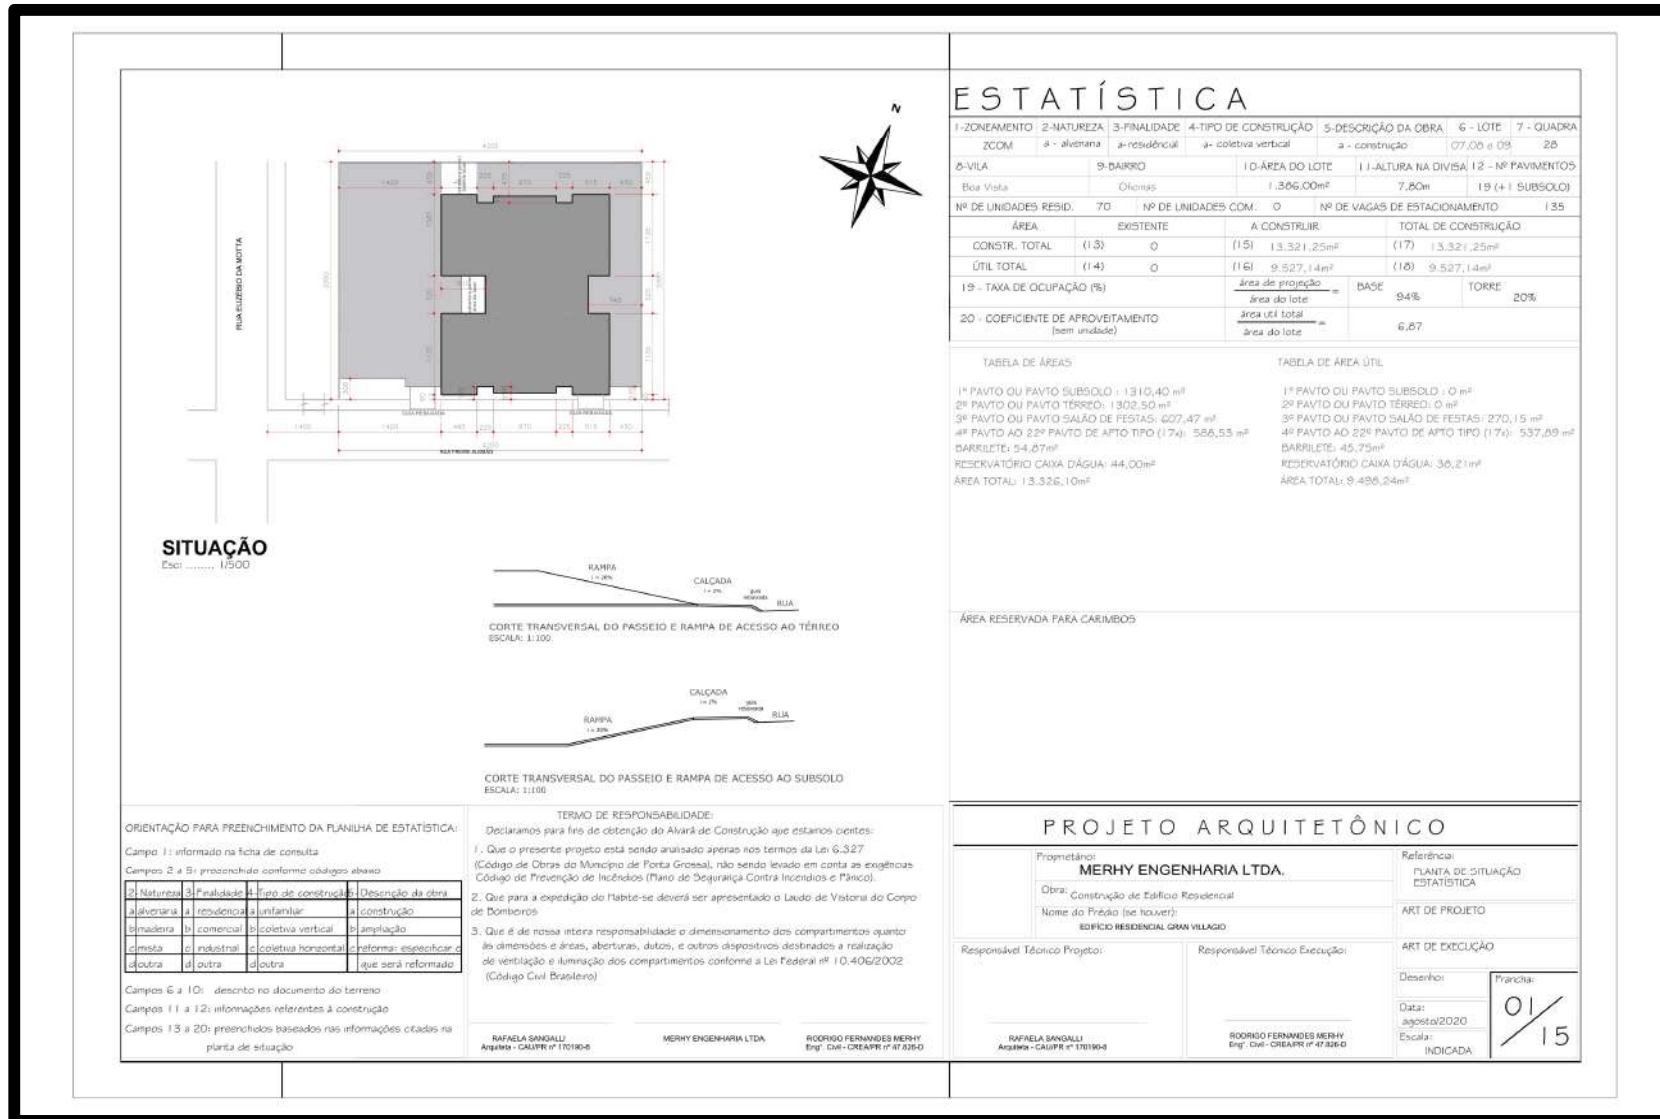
Planta de situação. Fonte: Construtora Merhy (2020).
